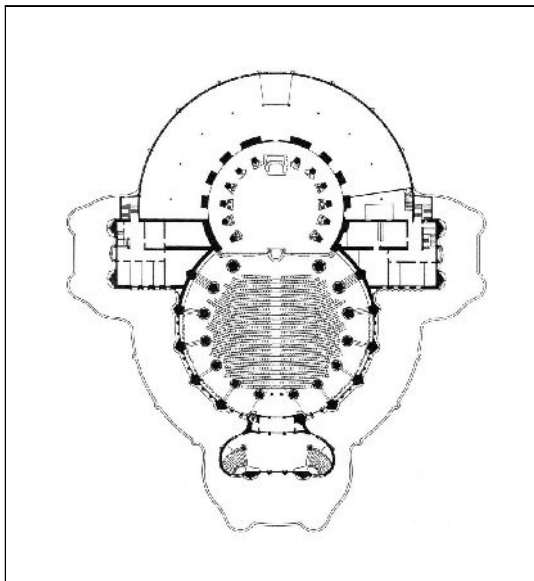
Il primo Goetheanum. Vista in pianta.
